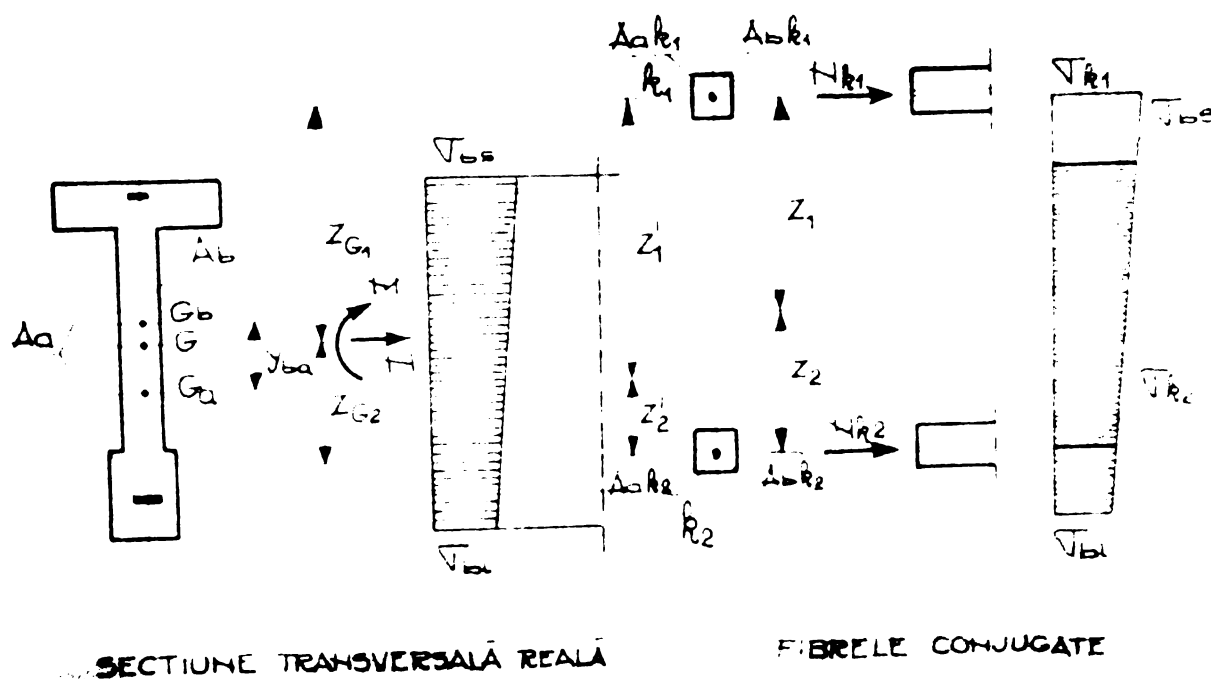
POZIȚIA FIBRELOR CONJUGATE LA O SECȚIUNE DE BETON ARMAT
